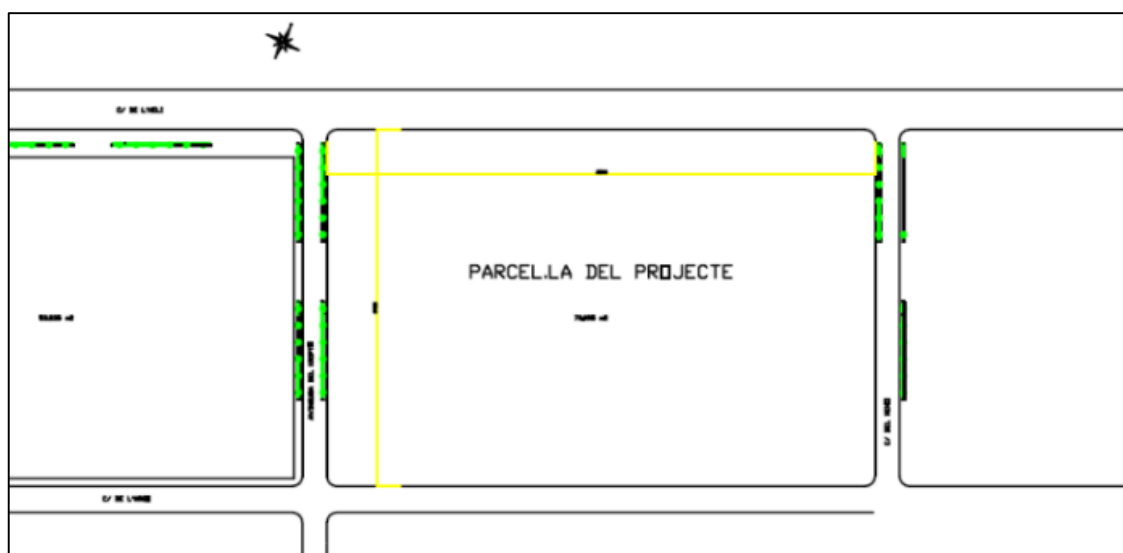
Plano de la parcela para la ubicación de la planta de CFC-13
